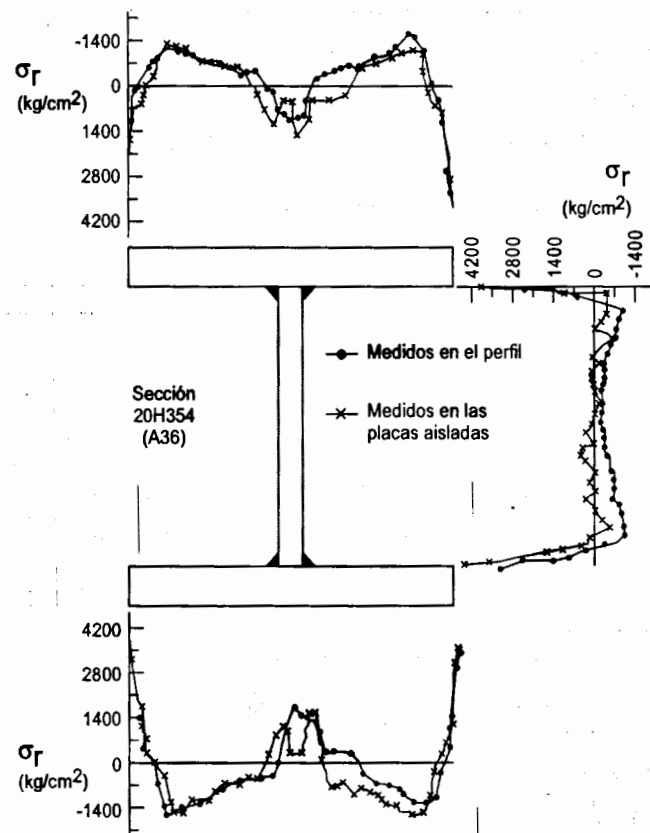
Esfuerzos residuales en una sección H soldada, hecha con placas cortadas con soplete.
